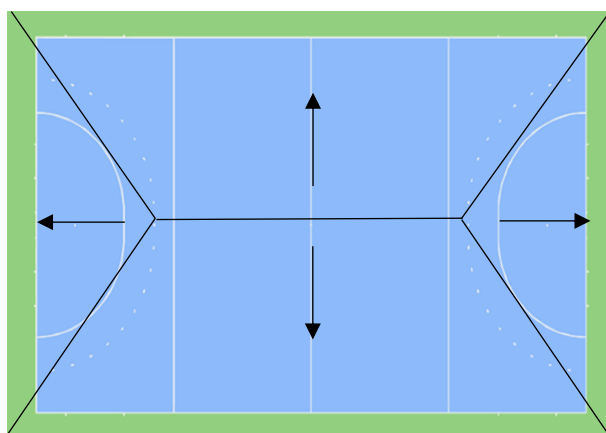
Perfil a 4 aguas, a menudo utilizado con construcciones de drenaje horizontal
